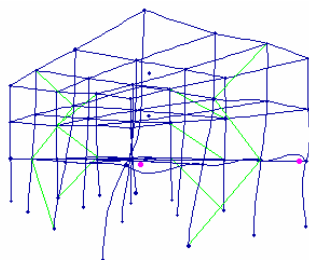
Formación de rotulas plásticas en la estructura con dissipadores
